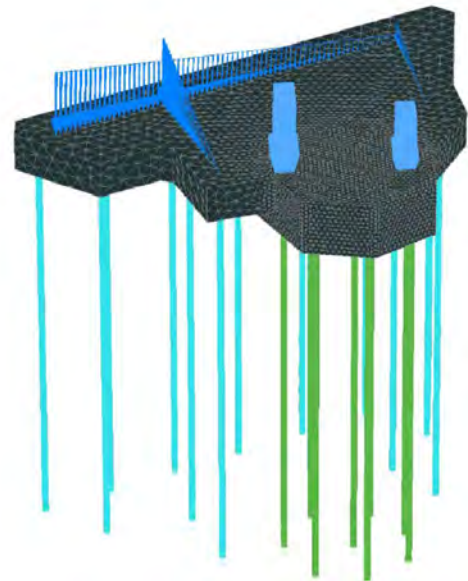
Péndulo Norte, modelo elementos finitos 3D. Vista de los pilotes, la losa encepado común y la transmisión de cargas estructurales.
